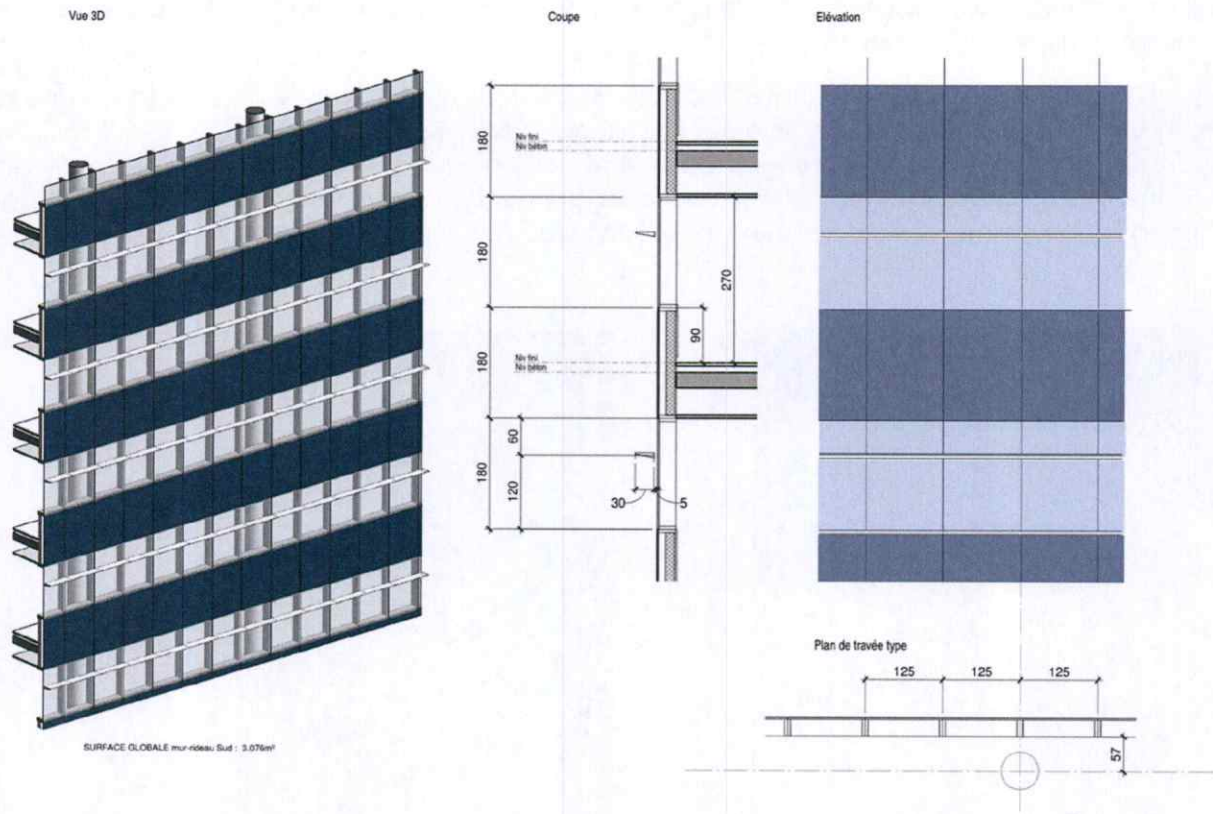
Traitement de la façade SUD équipée de brise-soleils horizontaux et panneaux photovoltaïques. (Extrait de la façade).
